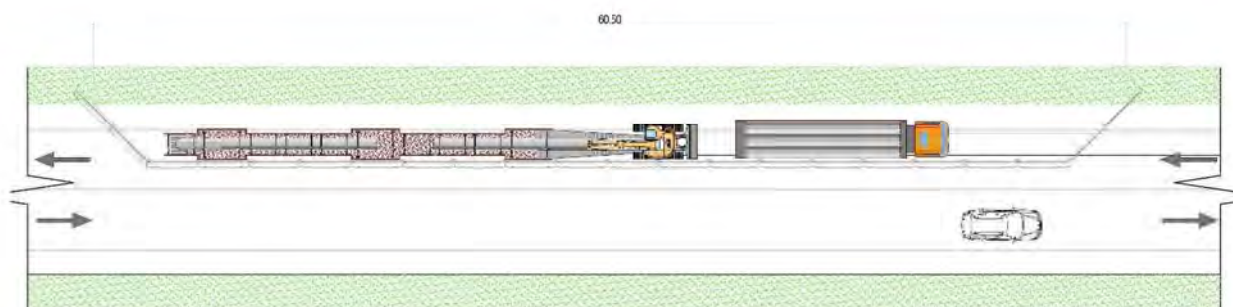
Layout COL - b. Scavo su strada e armatura fronti di cavo con blindaggi.
